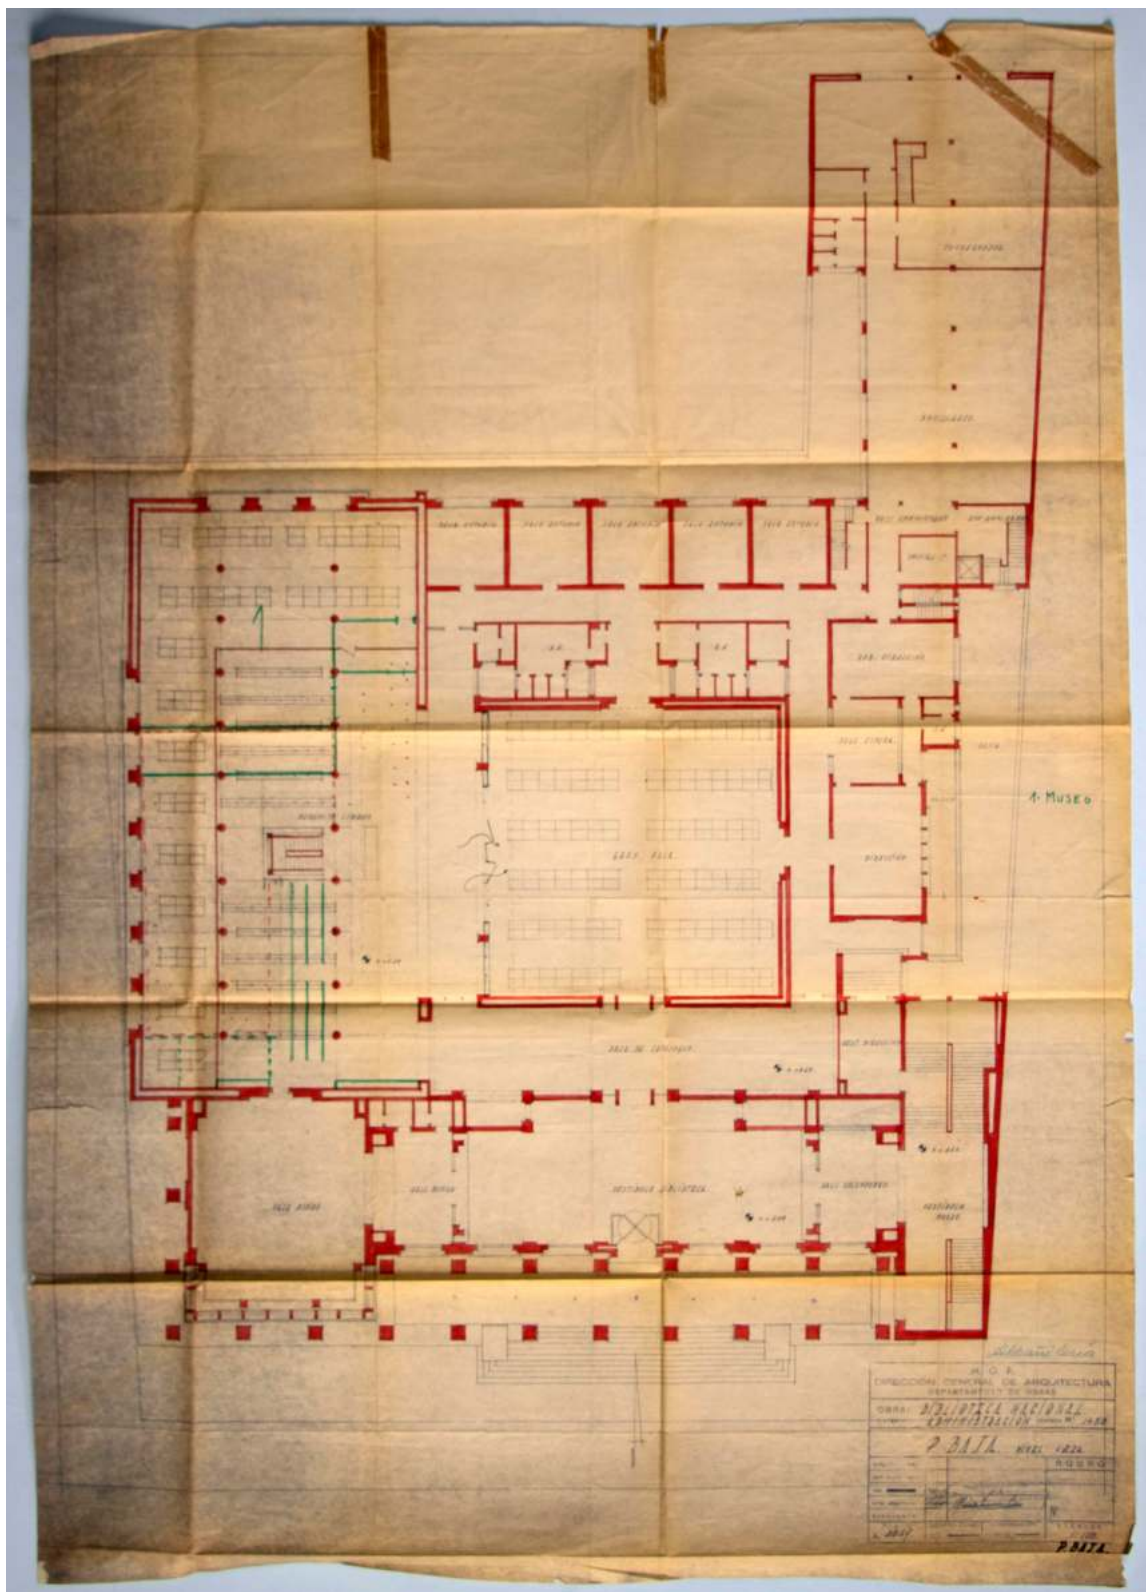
Planta baja del edificio. Plano de Albañilería. BN, Archivo Administrativo.
